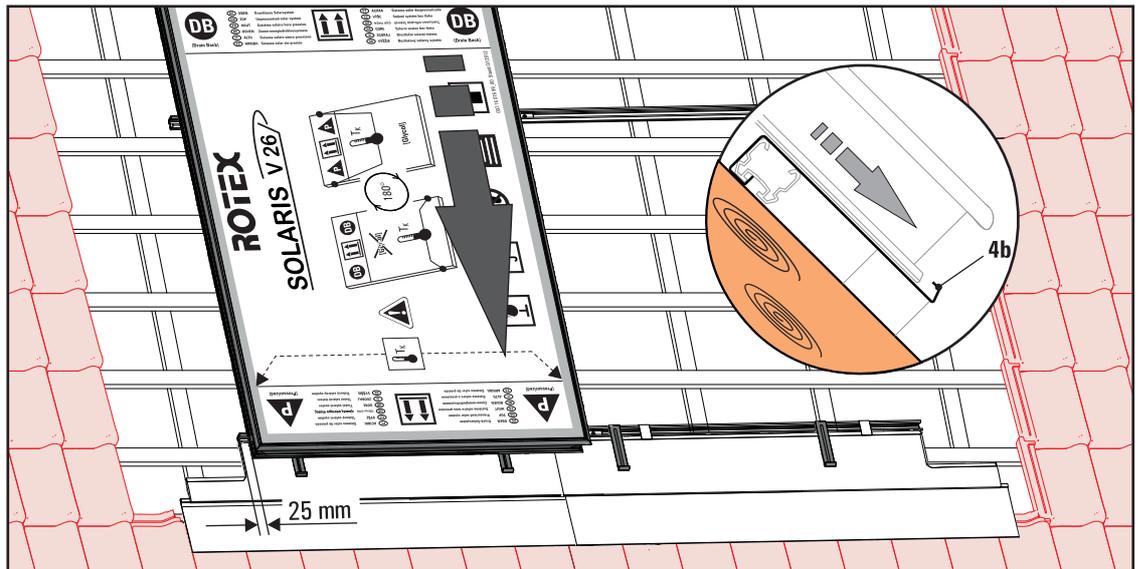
Sollevare il collettore piano sulle guide dei profili di montaggio, poggiarlo e sospenderlo cautamente ai ganci di fissaggio (4b). Rispettare le distanze! Rappresentato sul collettore piano V26P nel sistema Drain-Back
